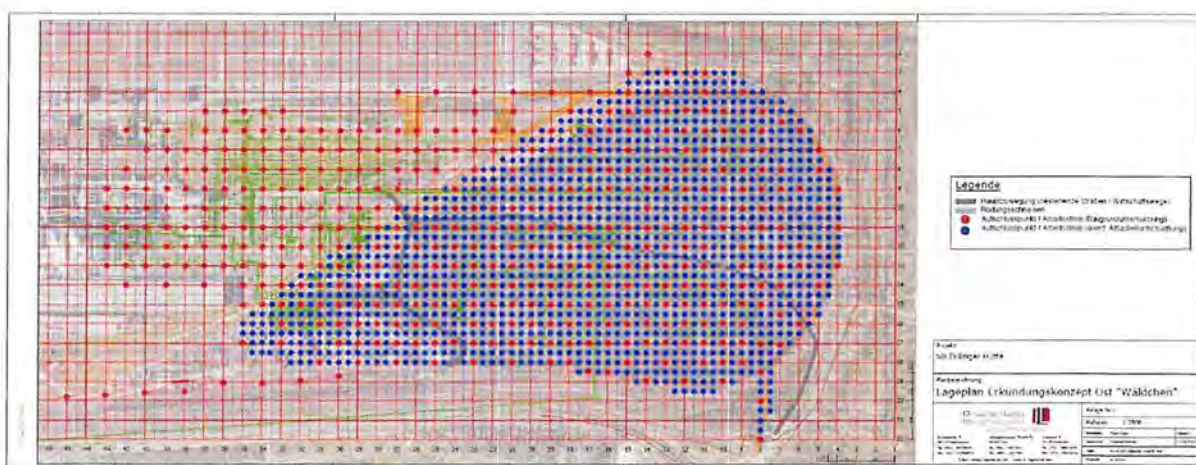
Erkundungslageplan, Büro für Geotechnik und Umwelt, Dr. Jung + Lang Ingenieure
